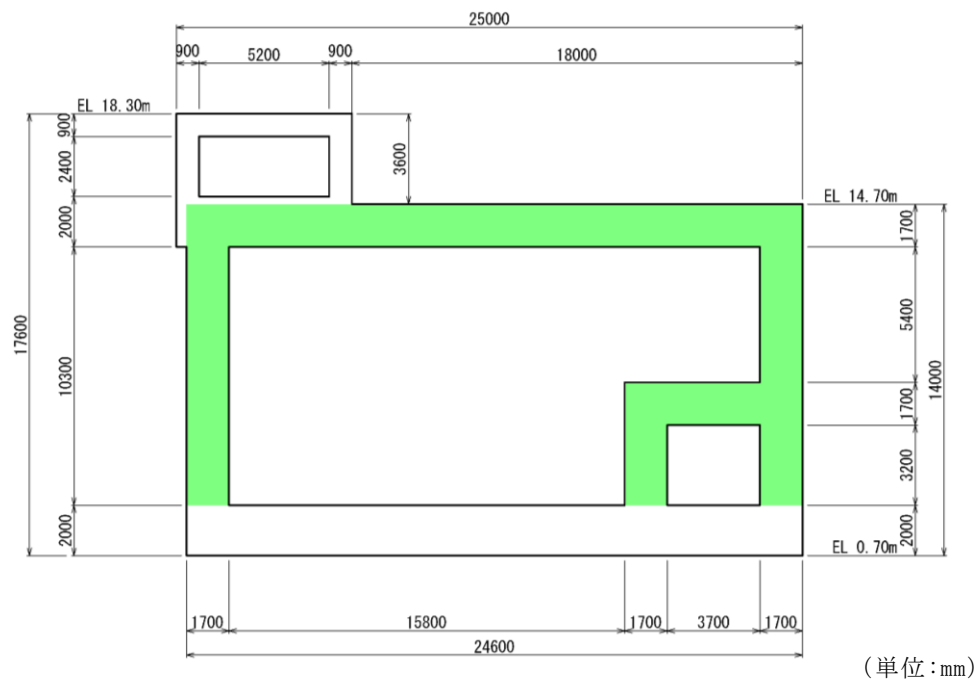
第 1 ベントフィルタ格納槽 断面図 (A-A 断面)
